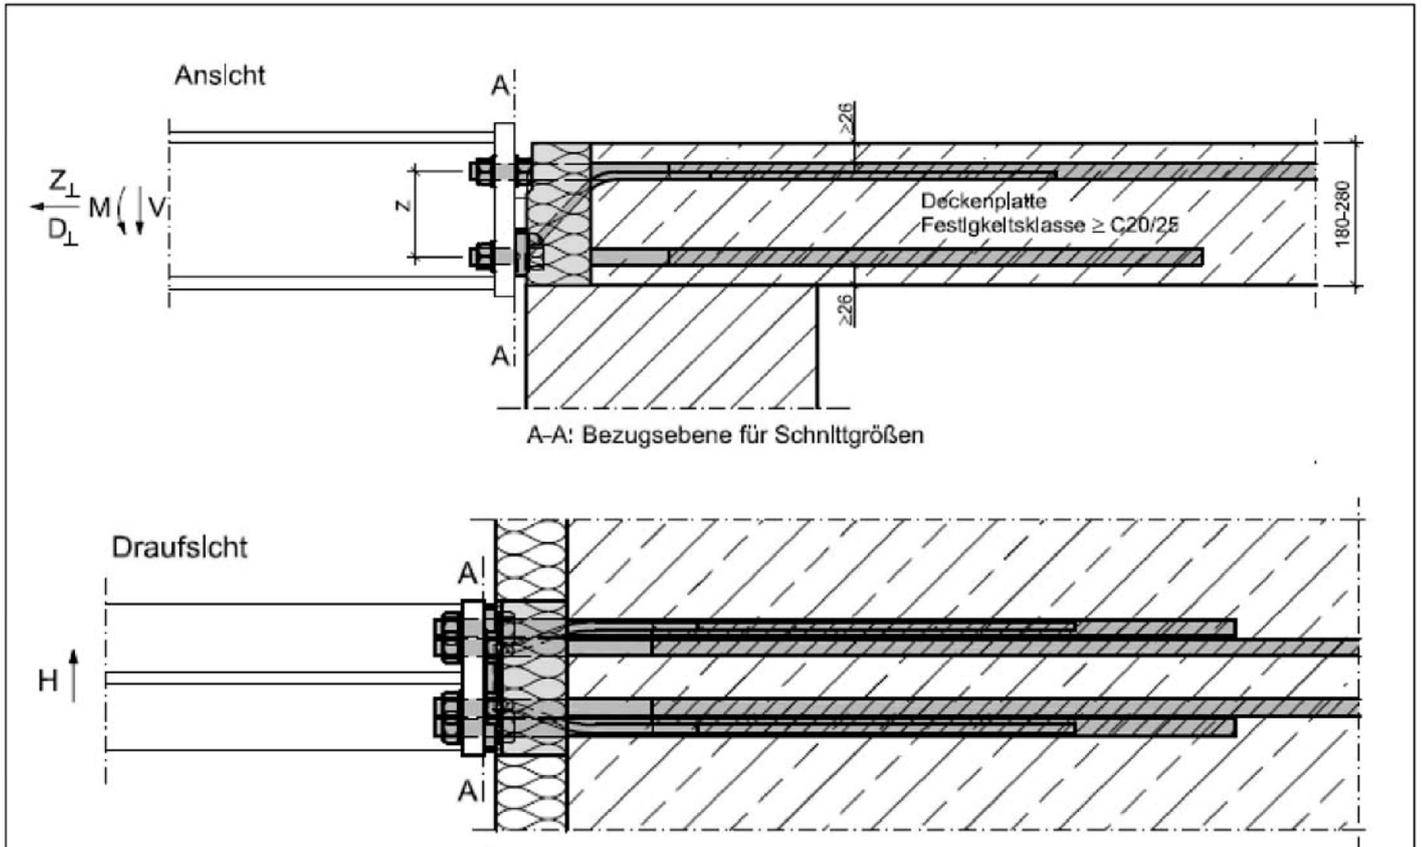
und 60: Schöck Isokorb® T Typ SK-MM2-VV2, Schnittgrößendefinition
